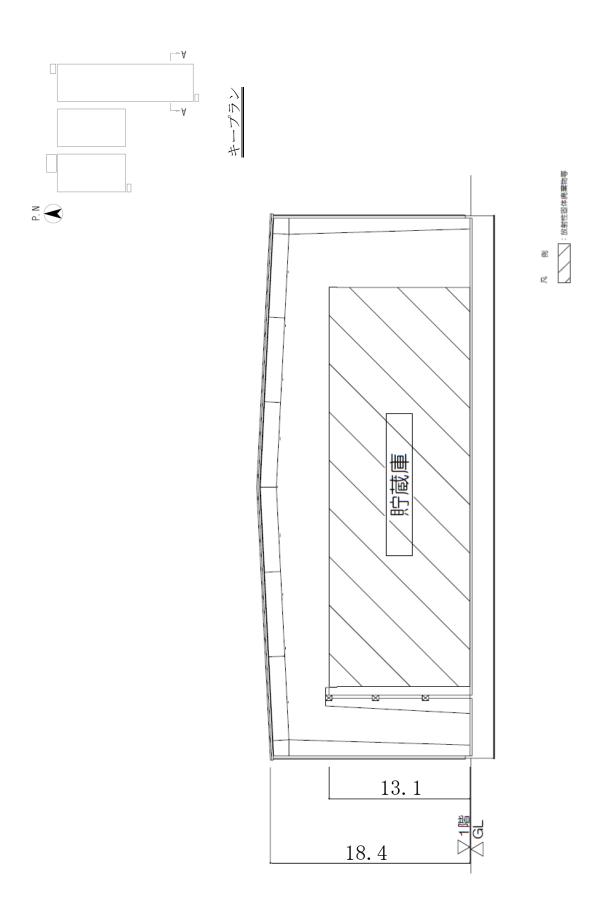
固体廃棄物貯蔵庫第10棟 平面図 (単位:m)
